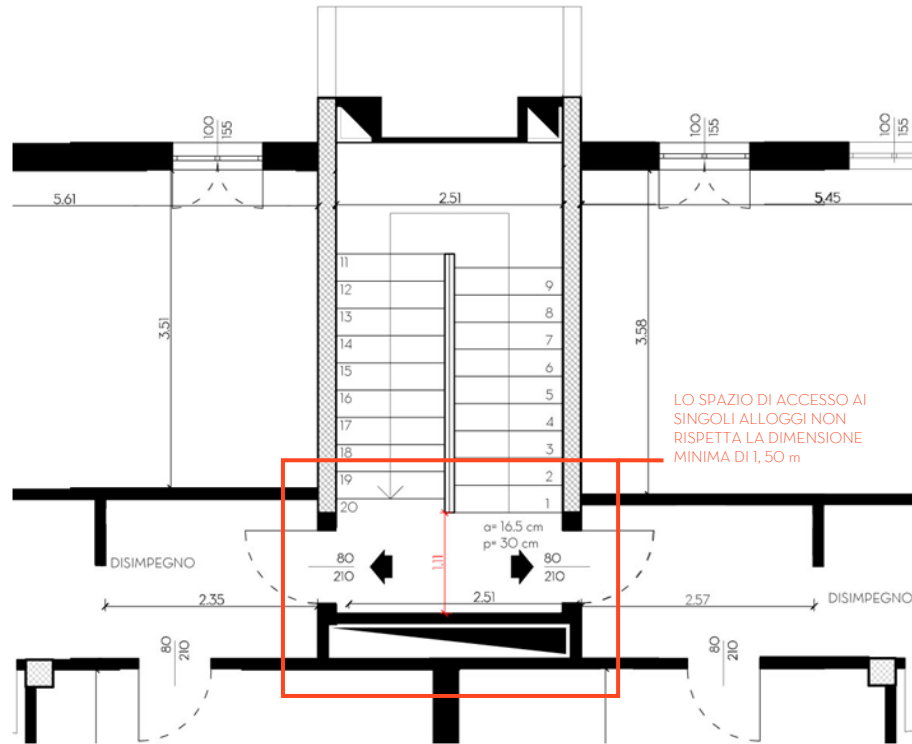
, Porzione Pianta Piano Tipo con vista corridoio di servizio .Tavola SF 13
